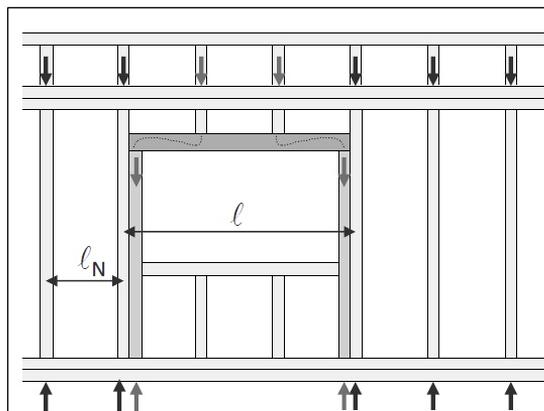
Schema di un architrave in una struttura intelaiata di parete.
